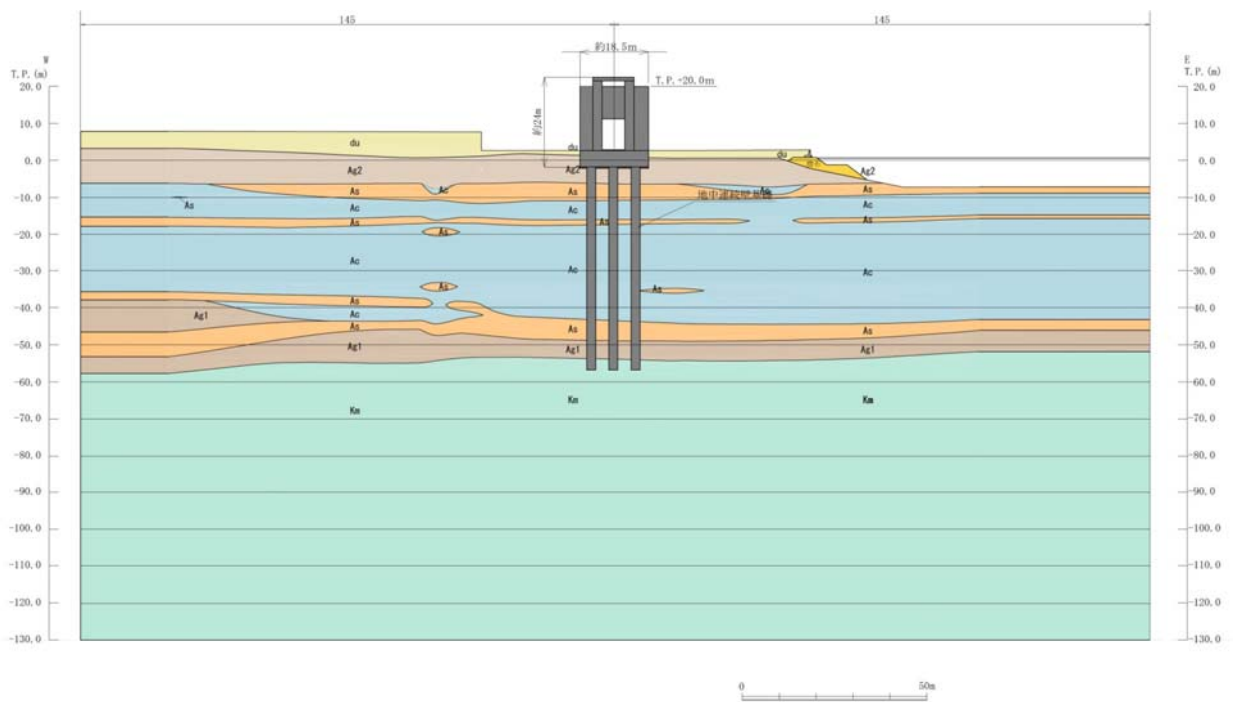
(2) 鉄筋コンクリート防潮壁 評価対象断面図 (②-②断面)
